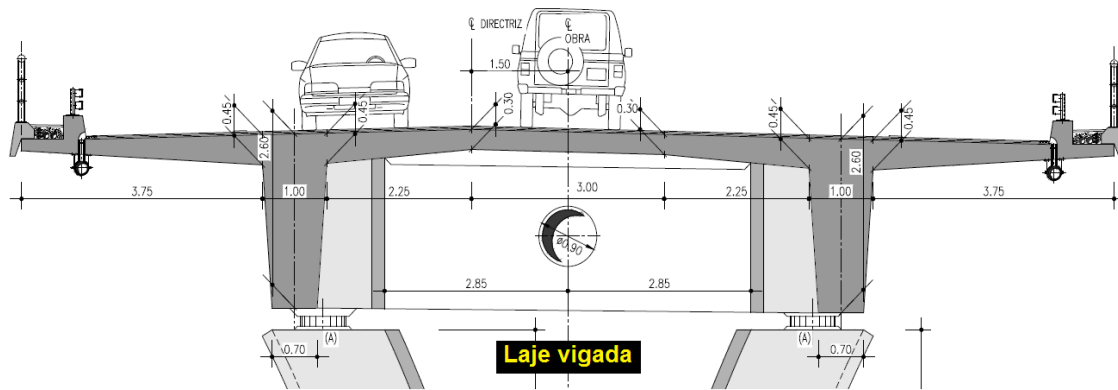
Secção do tabuleiro de uma ponte em laje vigada (Pedro, 2007).
